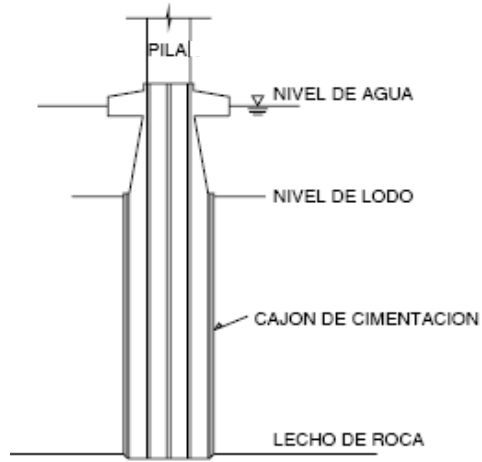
Cajón de cimentación. (Fuente: Guía para la inspección de puentes)
